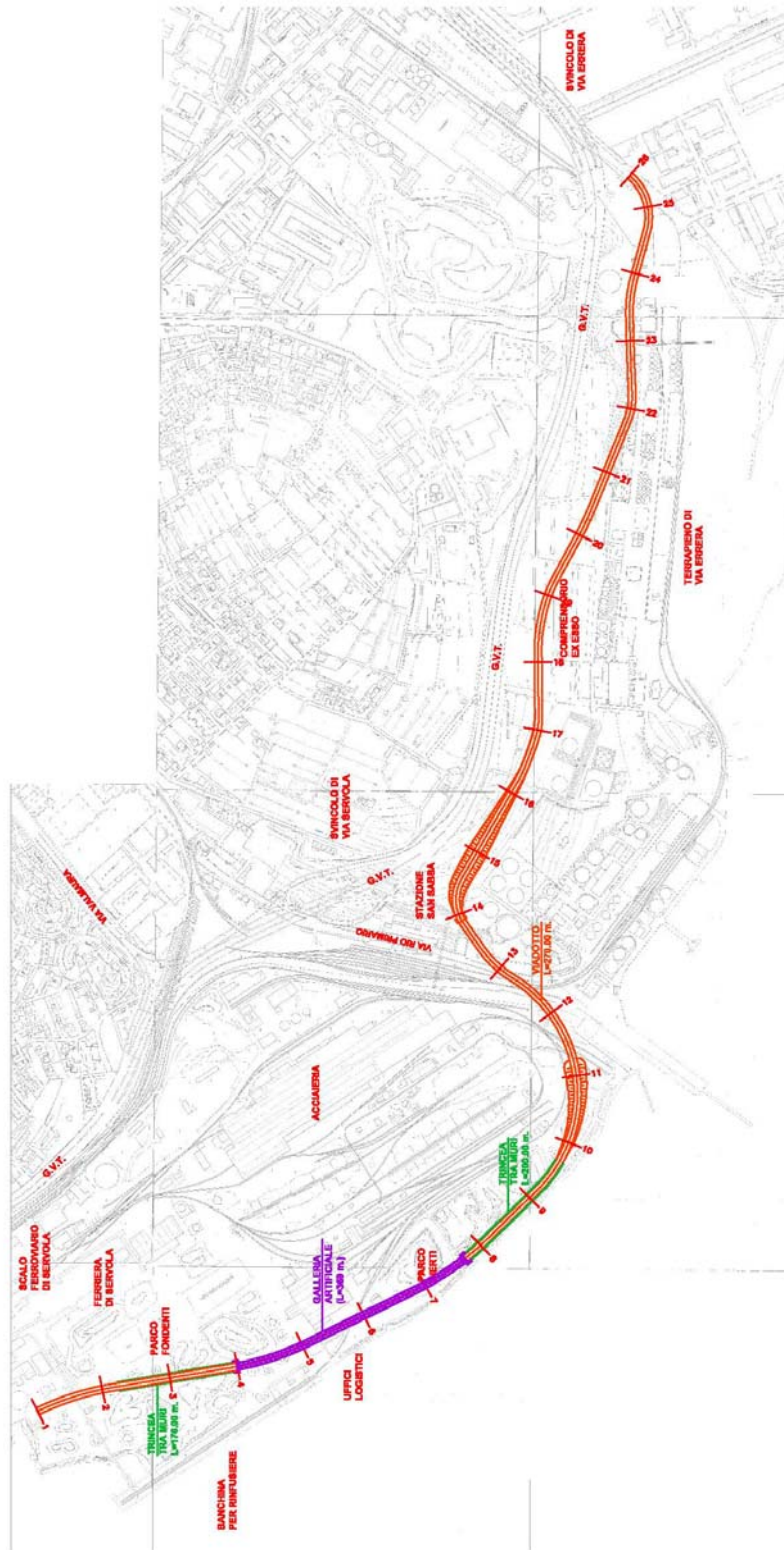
Collegamento di Piano Molo VIII - Grande Viabilità Triestina – planimetria
